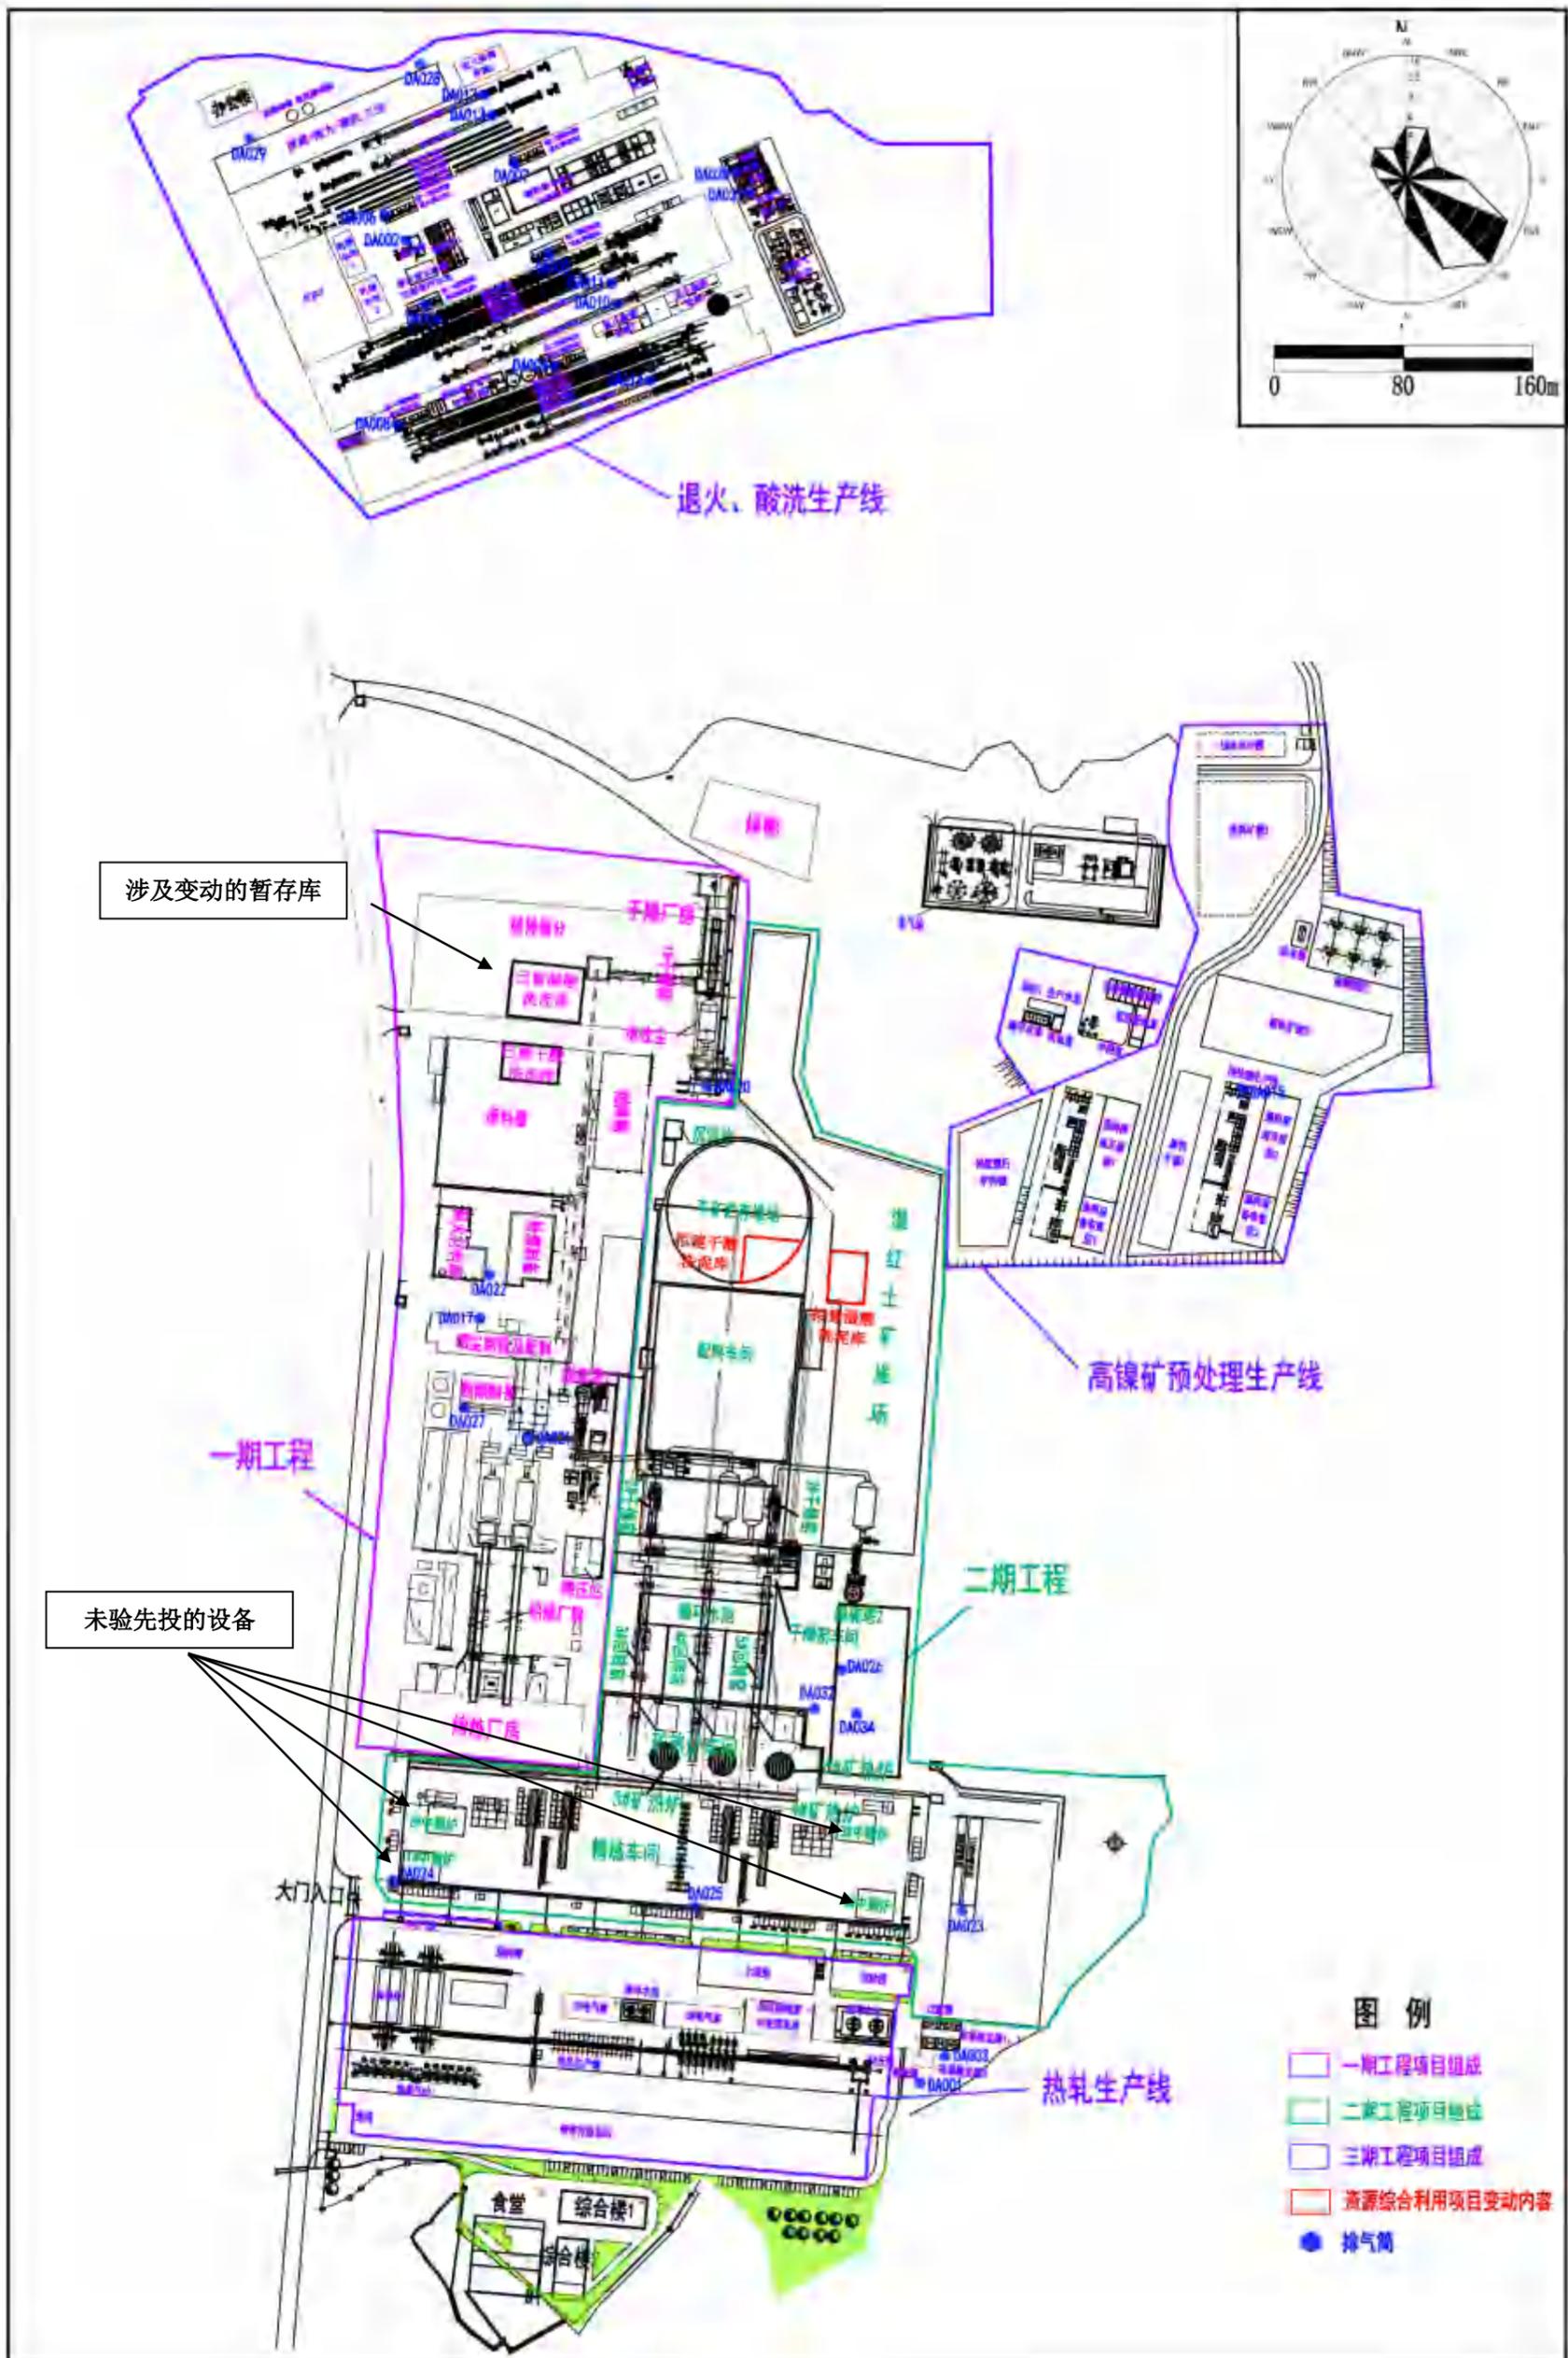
一期、二期、三期工程现状实际平面布置图
